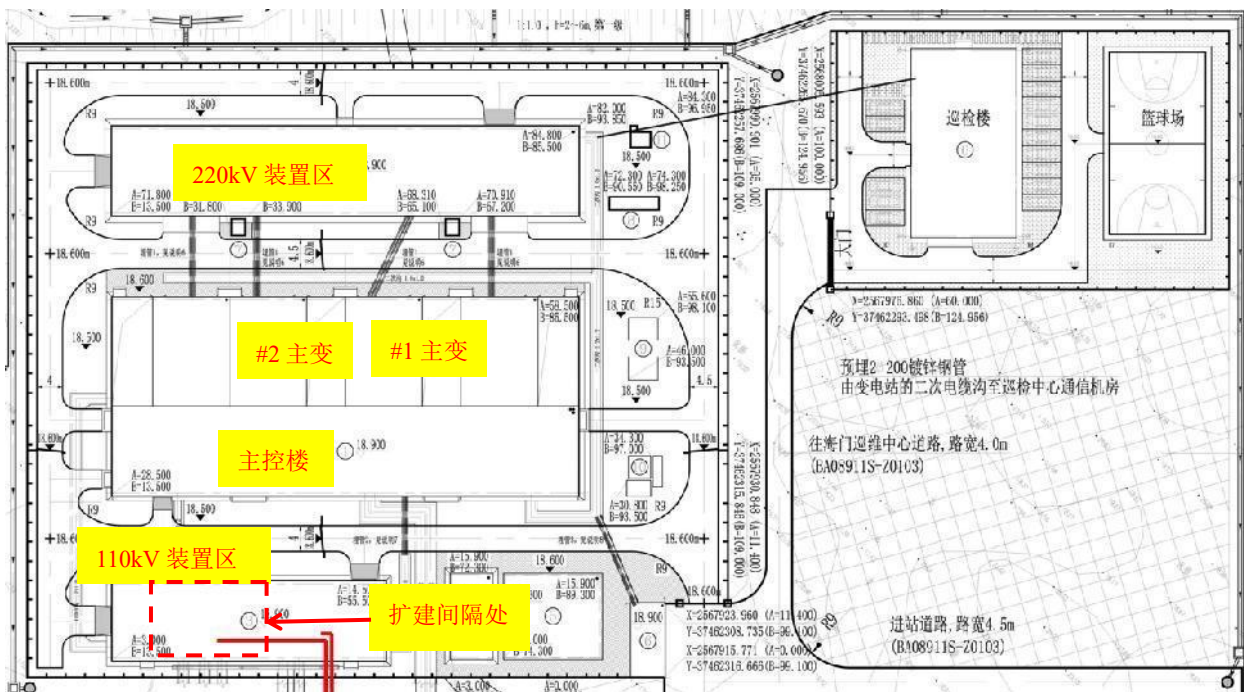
220kV 弼臣站总平面布置示意图（扩建后）
